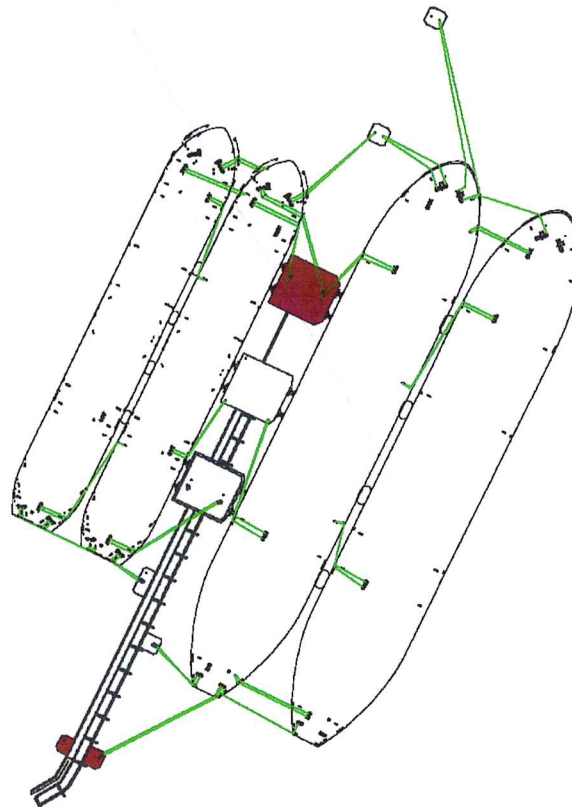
Estruturas sujeitas a falhas no Píer Norte
